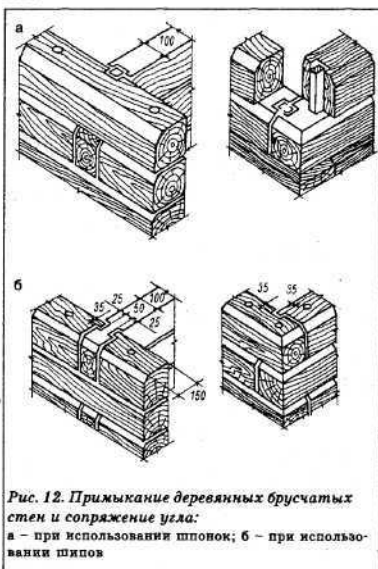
Примыкание деревянных брусчатых стен и сопряжение угла:
